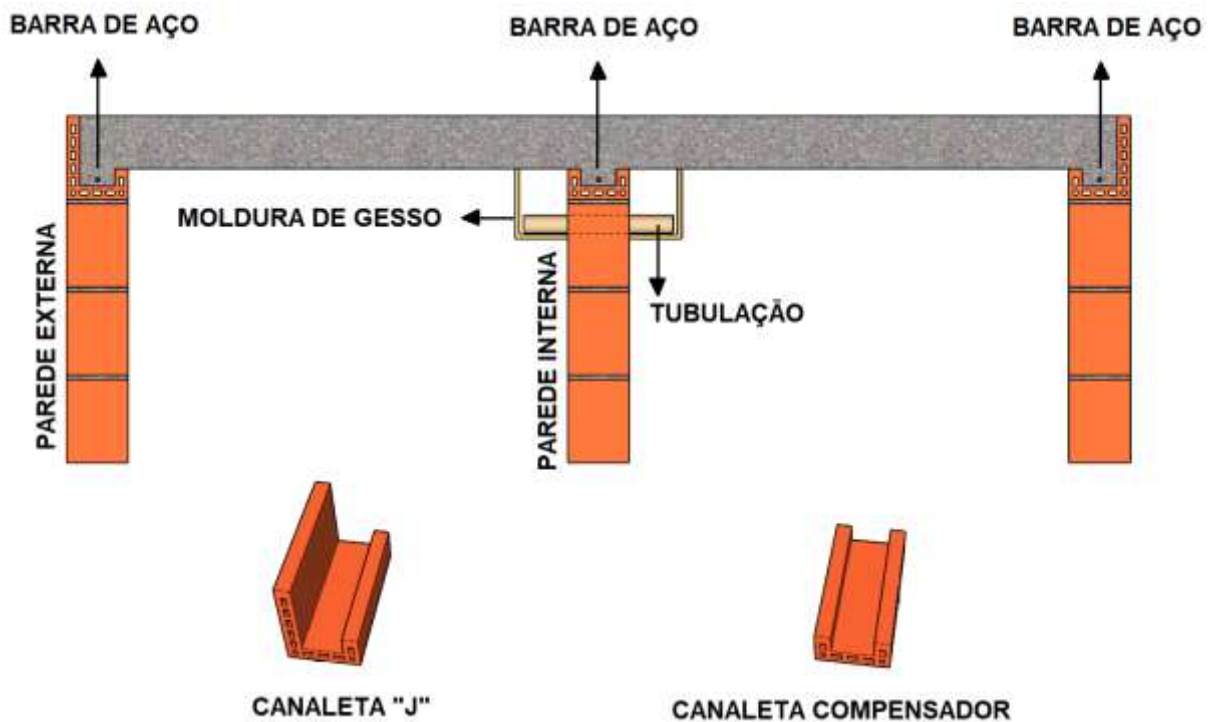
Detalhamento sob a laje. Fonte: Própria.
